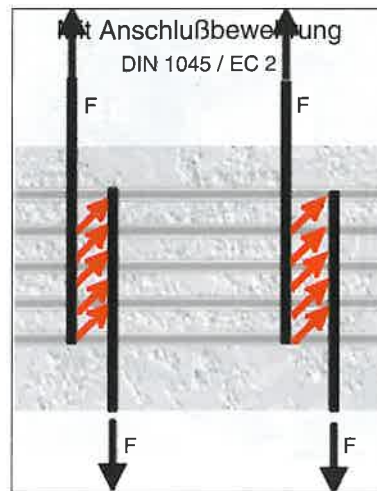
Eingemörtelte Bewehrungsstäbe mit Anschlussbewehrung
